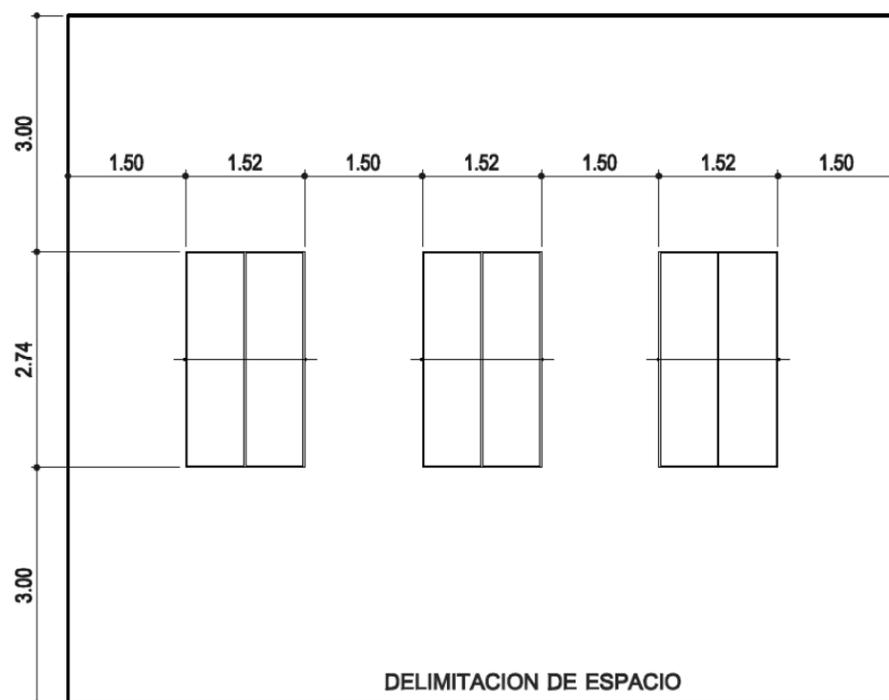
PLANTA MODULO DE JUEGO PING-PONG
